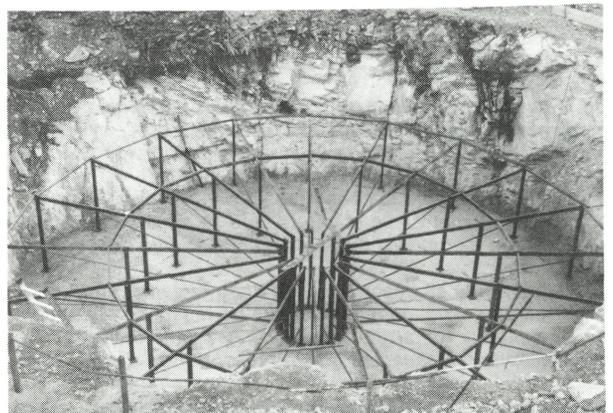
Excavación de zapata y bastidor soporte de la armadura superior
